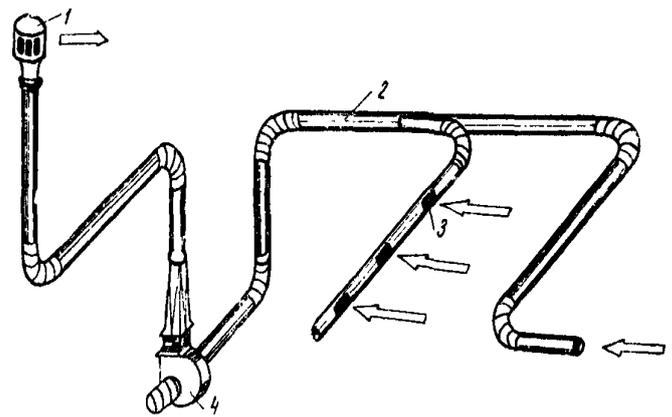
Схема системы вытяжной механической вентиляции с разветвленной сетью воздуховодов:
